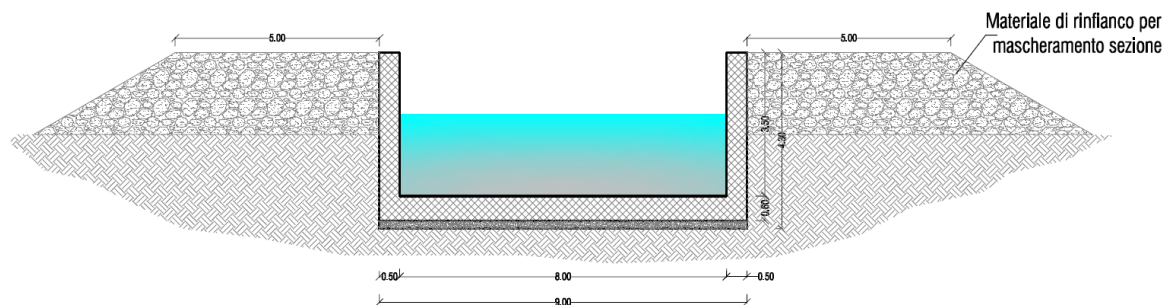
Sezione lama Scorbeto tratto artificiale
